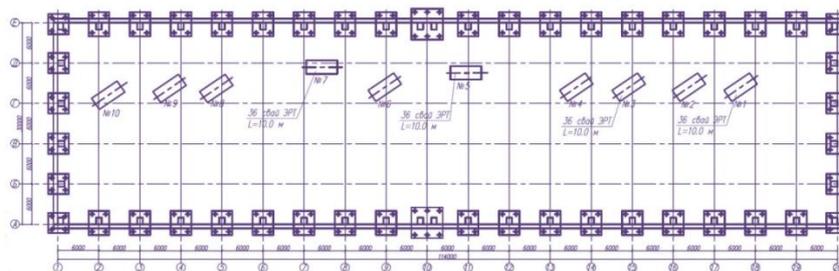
План свайного поля из буроинъекционных свай ЭРТ
